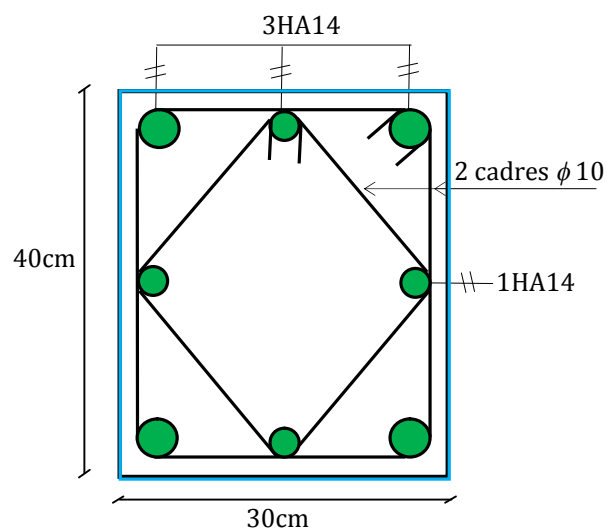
Schéma de ferrailage des poteaux 9^{eme}, 10^{eme} étage et buanderie.
